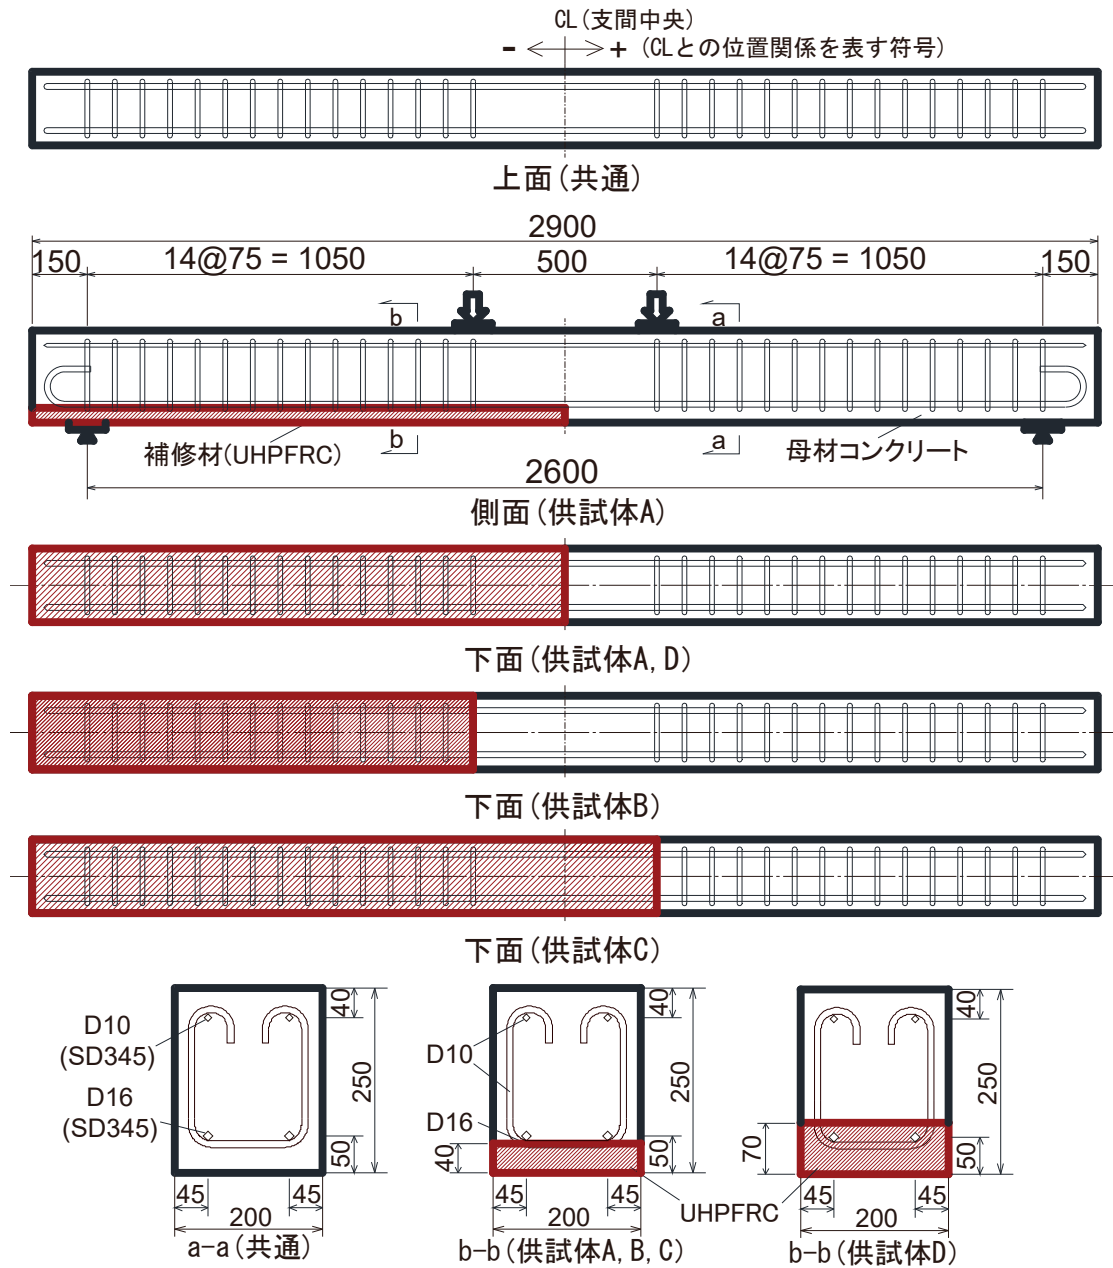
上面部分補修を模擬したはり供試体の諸元
